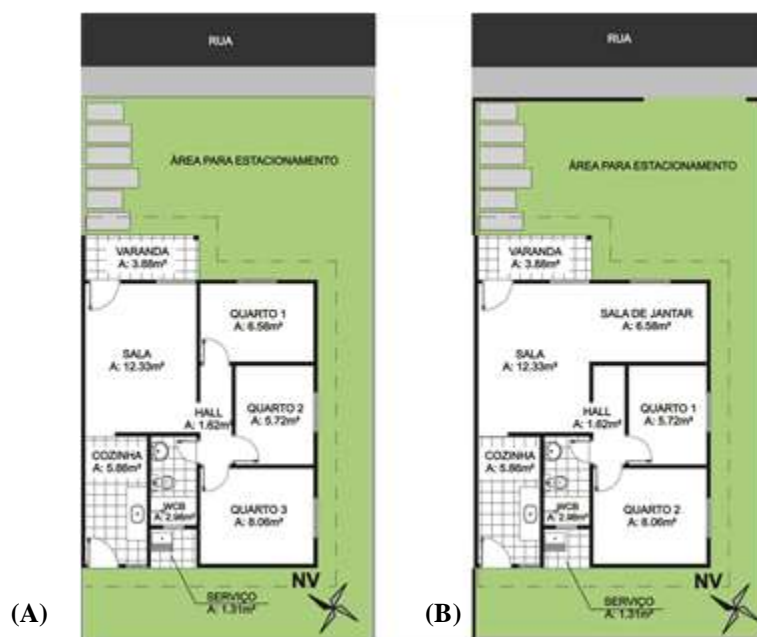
(A) Planta baixa original da edificação segundo projeto arquitetônico; (B) Nova configuração arquitetônica após intervenções do morador.
